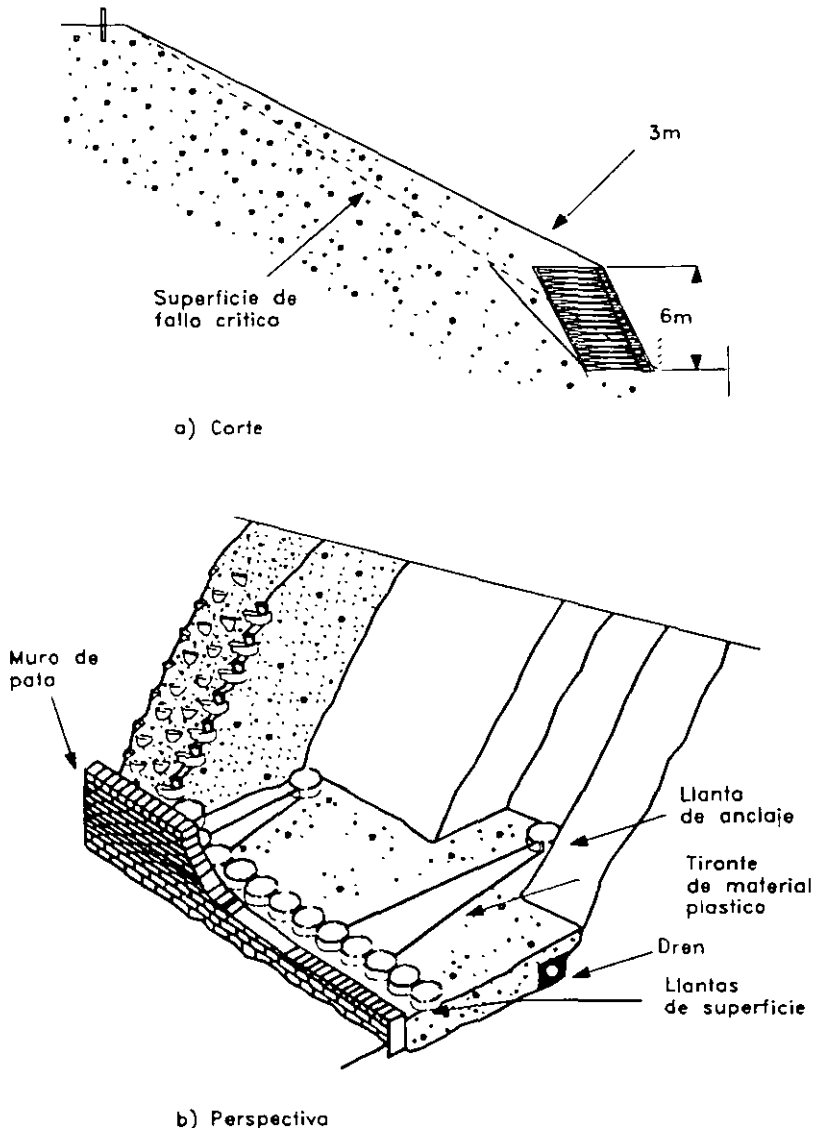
Muro armado con llantas usadas, utilizando llantas con tirantes elemento de anclaje.
